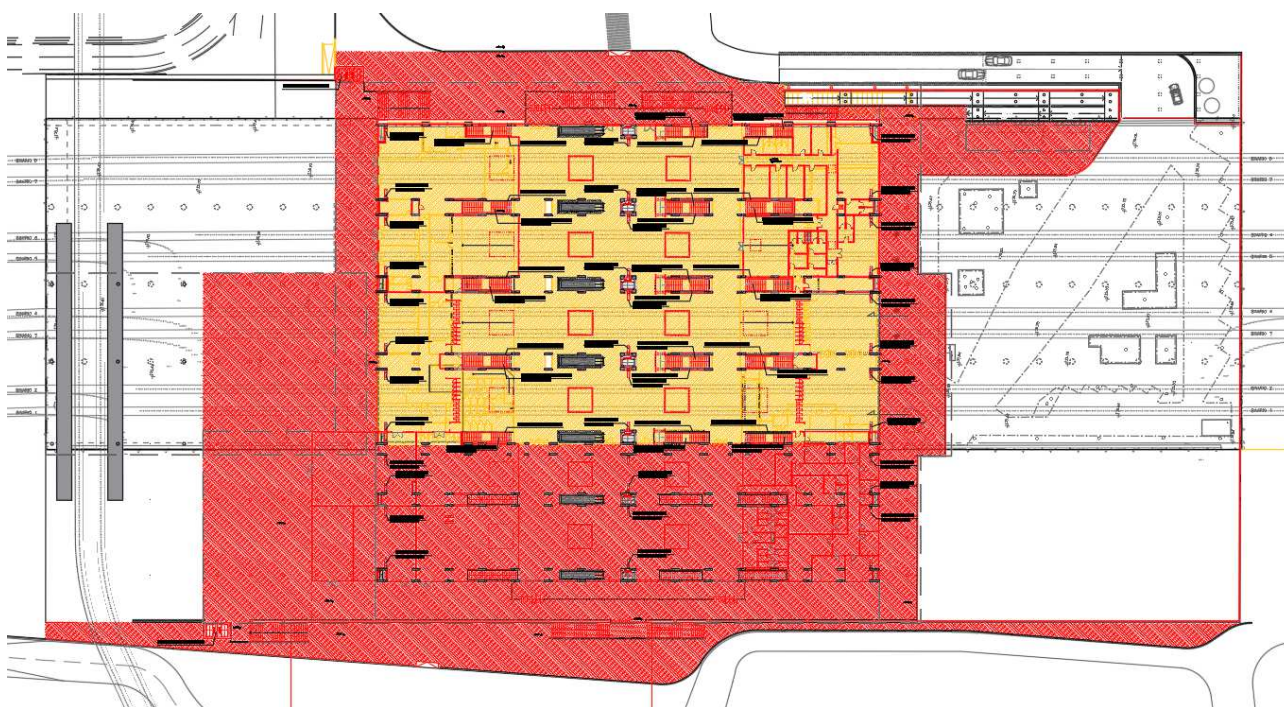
Planimetria demolizioni Piano Ingressi (demolizioni in giallo)
